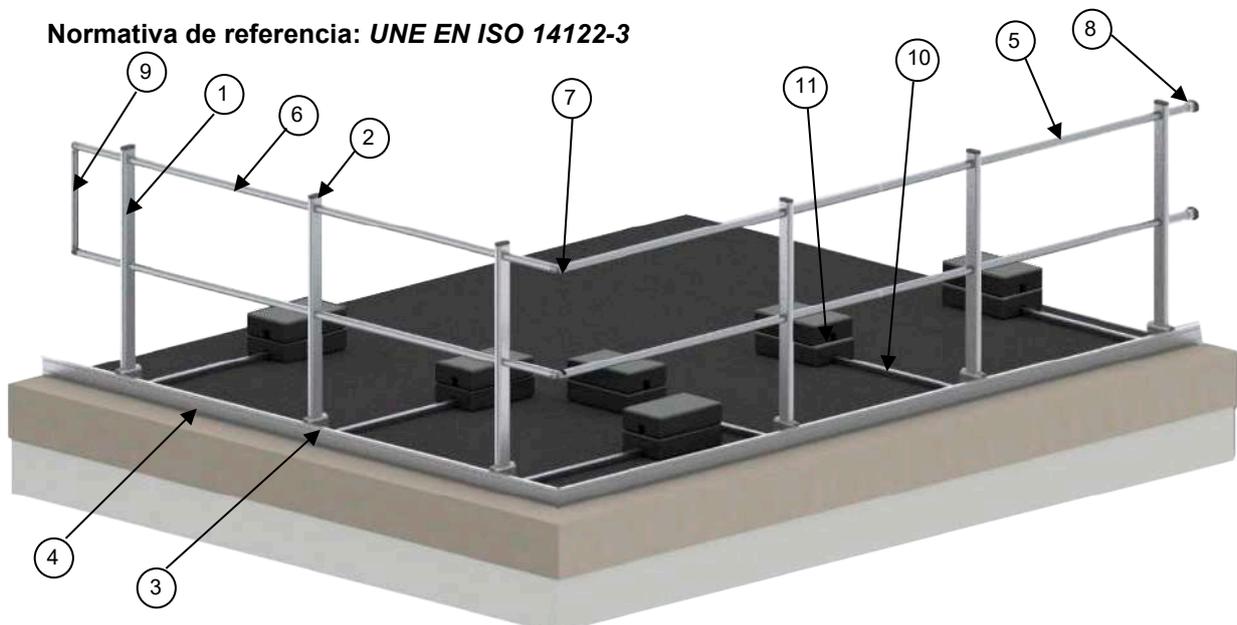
a – Componentes constructivos del parapeto autoportante fijo.
